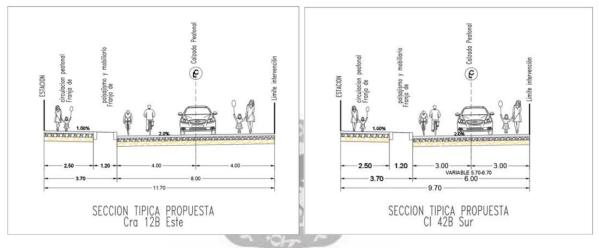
Geometría vial proyectada. Estación Altamira.
